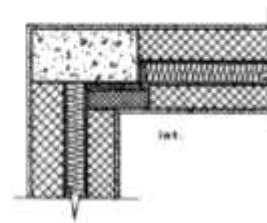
A-4: Pilastro d'angolo: correzione del ponte termico mediante variazione di forma del pilastro e impiego di materiale isolante.
